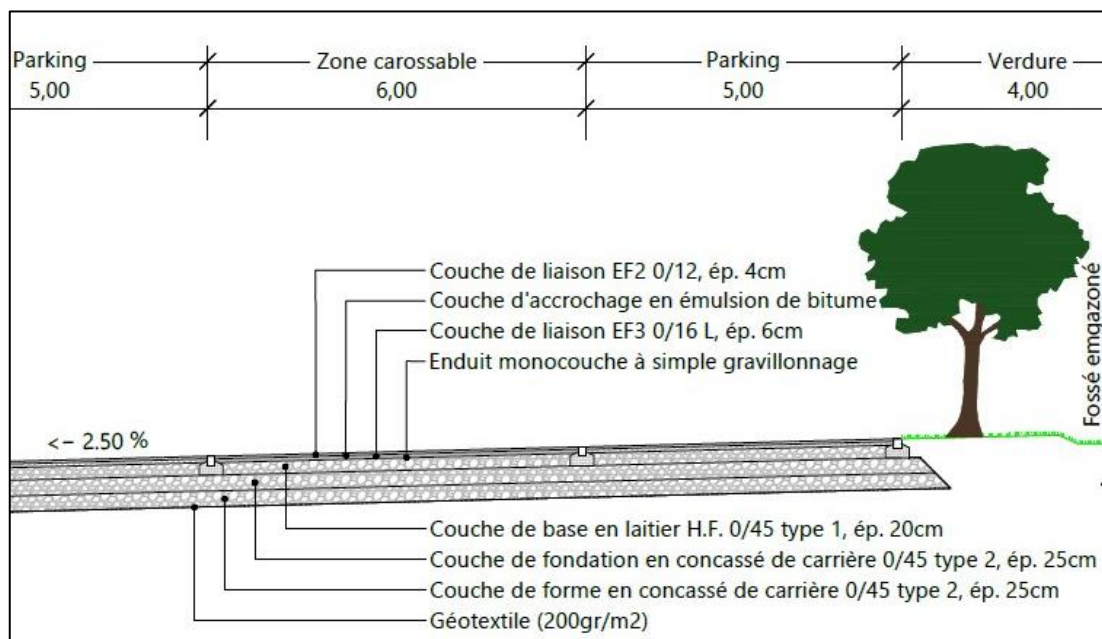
Extrait de la coupe relative aux couches planifiées du parking - zone « Voie de circulation ».
